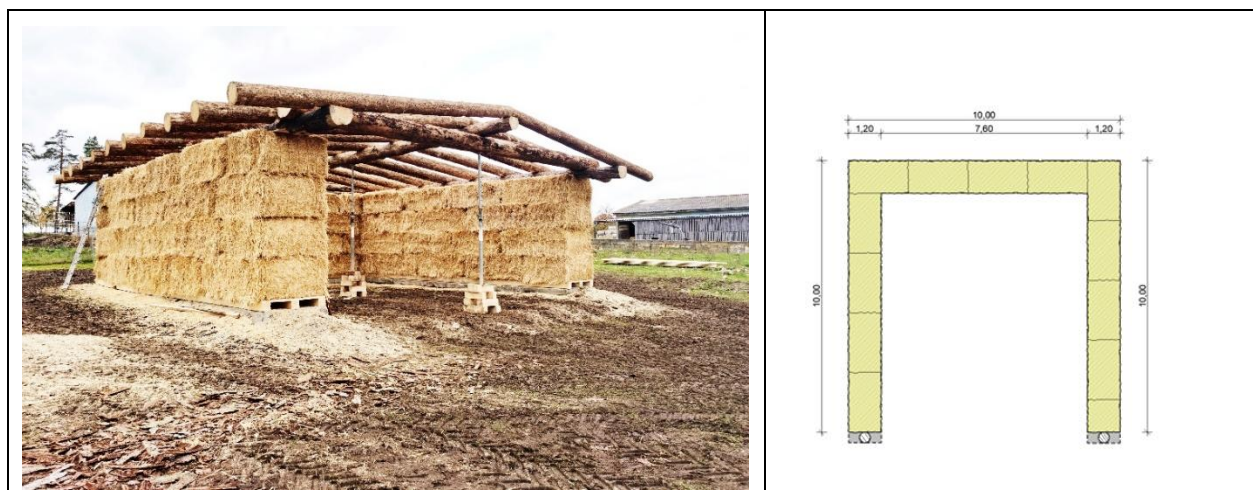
Schafstall im Hof Herten, Grundrissplanung (rechts) und Rohbauzustand (links)
